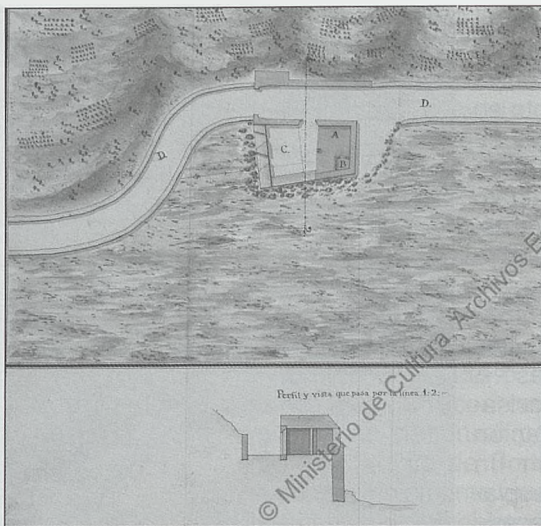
Plano y perfil de la batería situada en la Calzada de Santoña, por Joaquín del Pino, 1763 (AGS, MPD, 25, 122)
